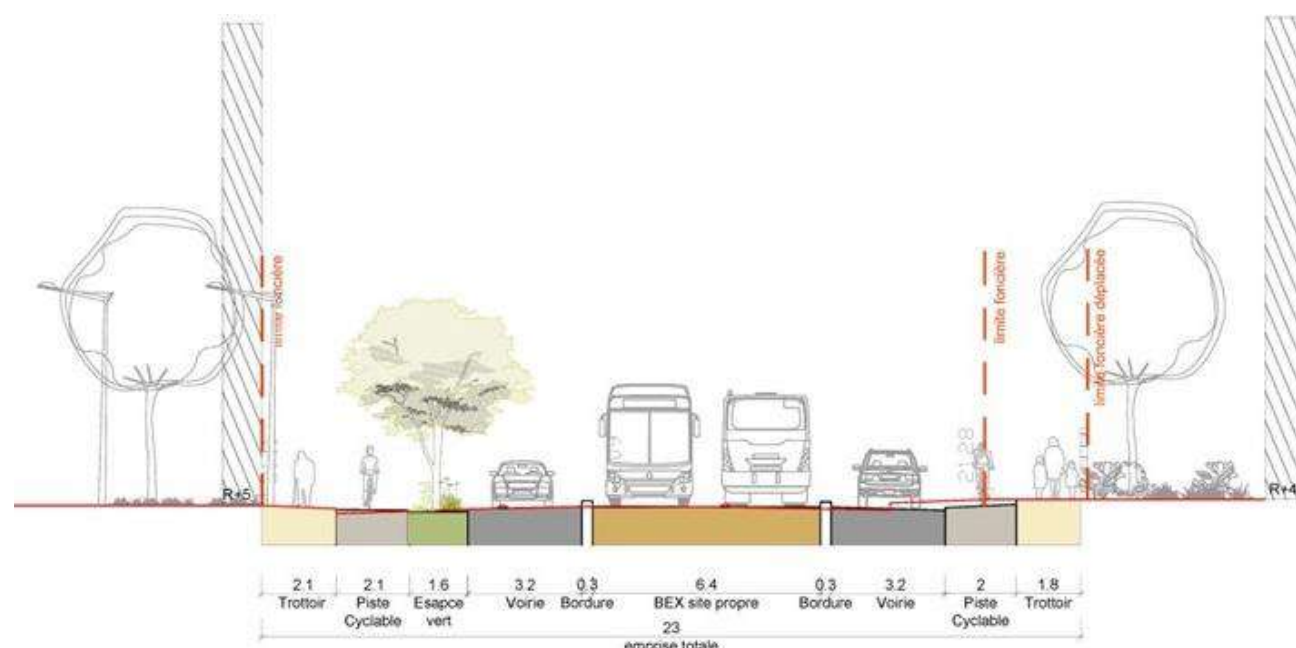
Coupe type sur la rue du Tauzin en section courante
